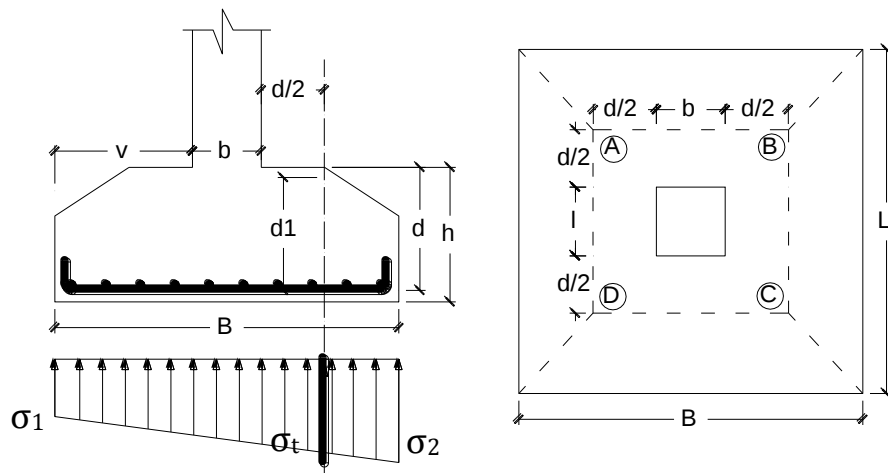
Cálculo a Corte en zapatas rígida (caso I)
